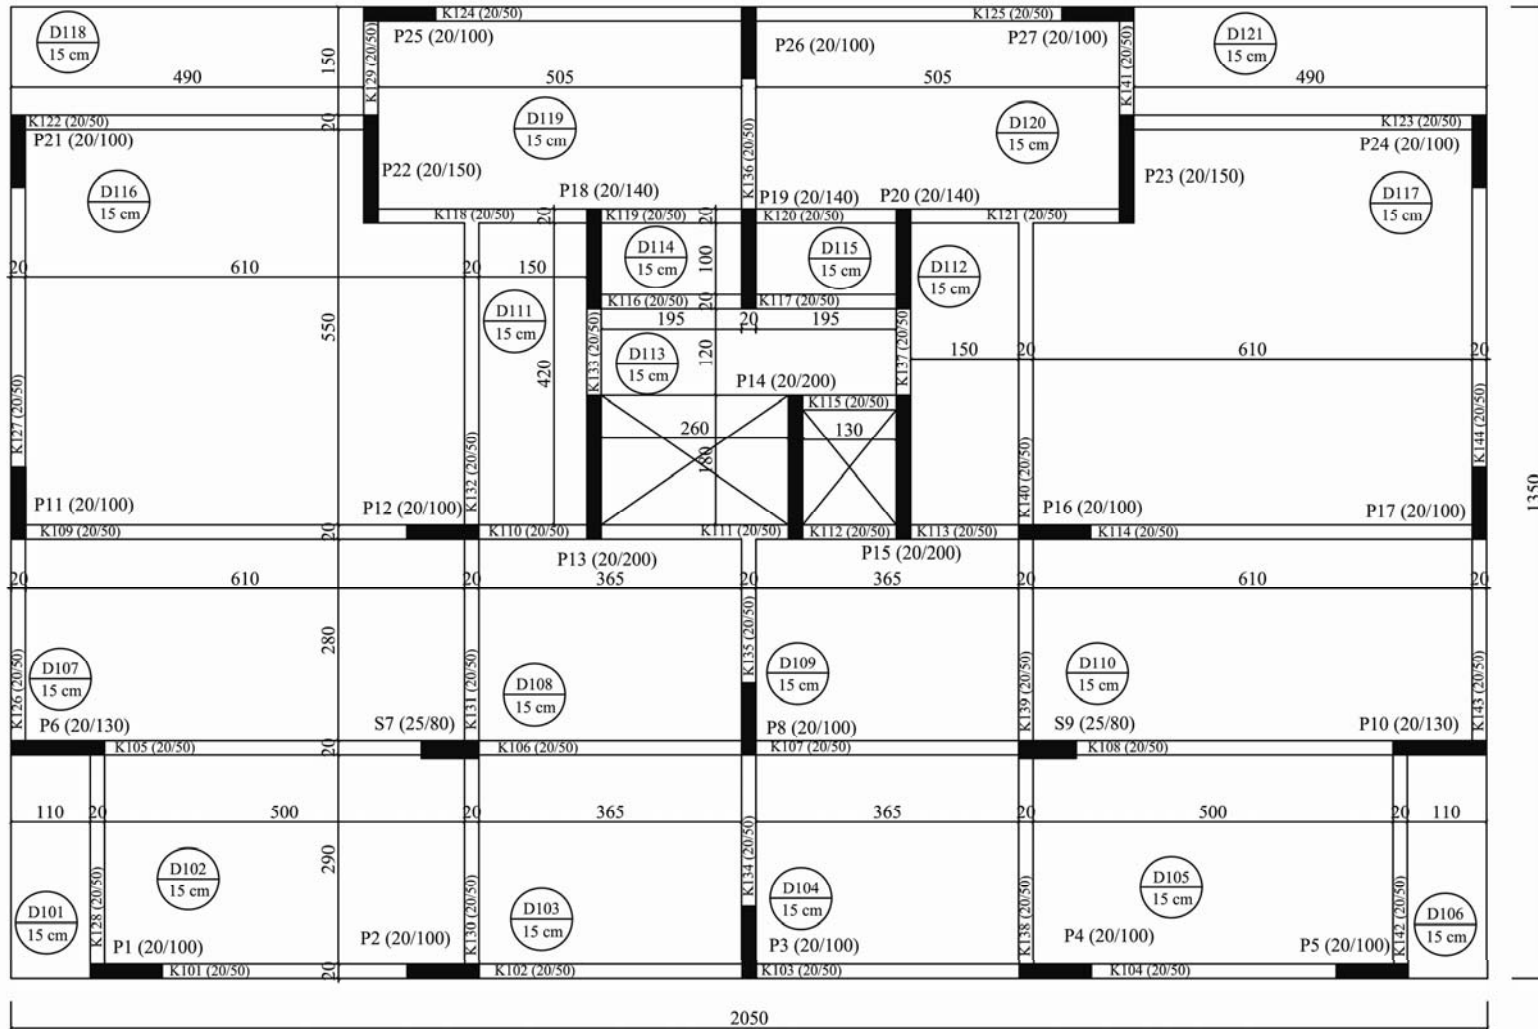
B6\_3'ün 2., 3., 4., 5. ve 6. kat kalıp planı
